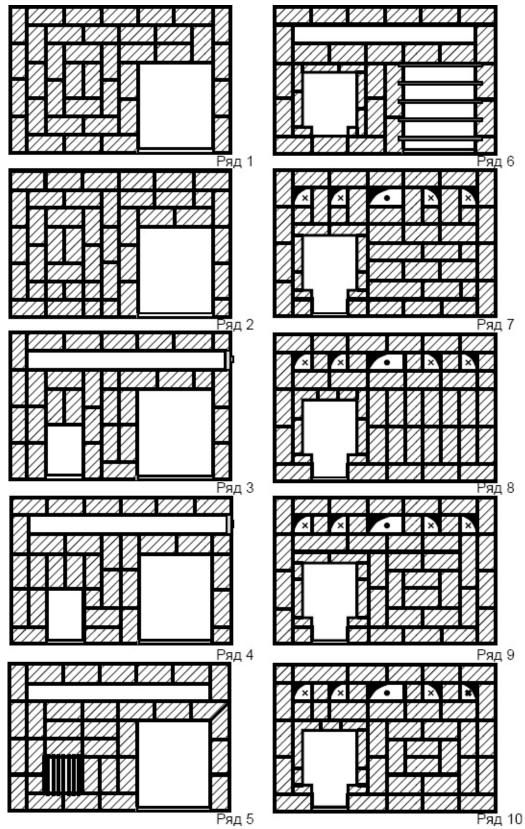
Схема кладки (порядовки) двухкамерной коптильни из
